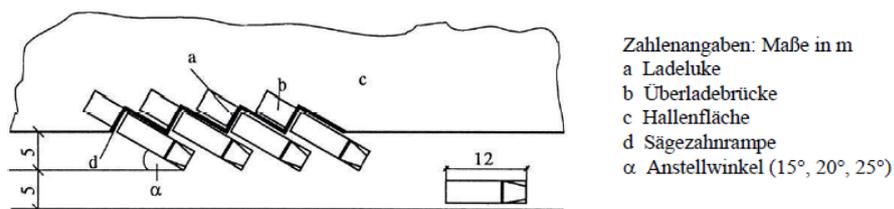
Laderampe mit Sägezahnrampe⁵¹
